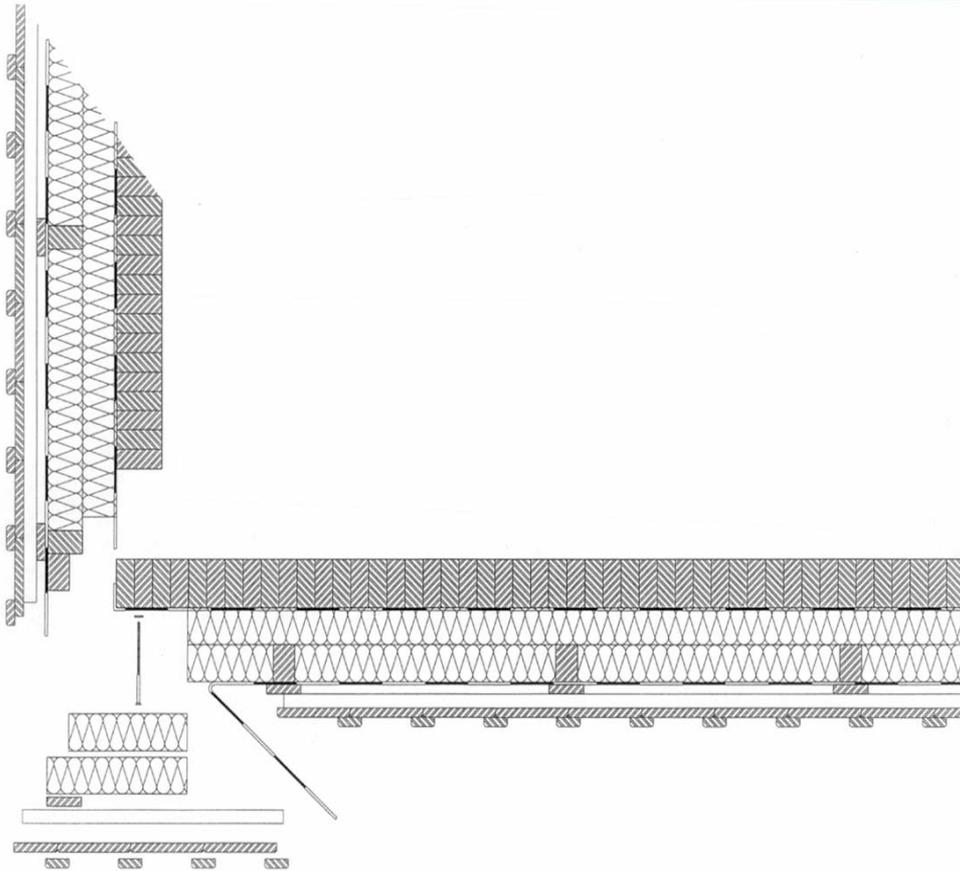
Eckdetail Wohnhaus, Schnitt waagrecht:
